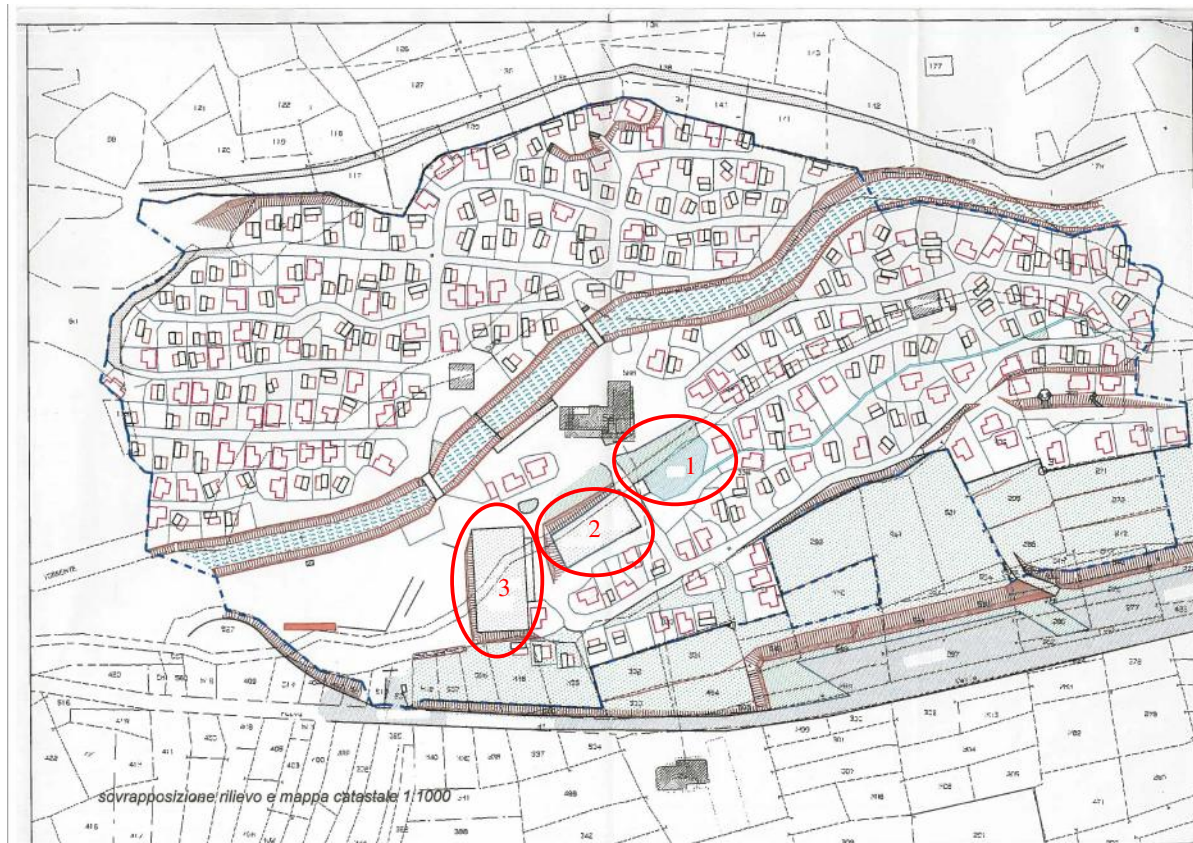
rilievi ottobre 2015 su planimetria catastale con individuazione campo da tennis, campo da calcetto e laghetto artificiale con pontile
